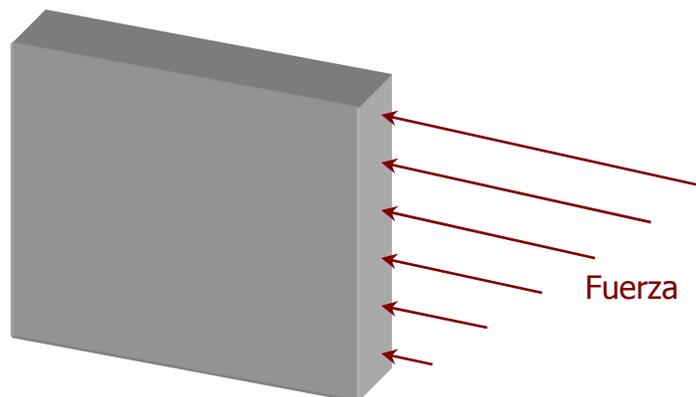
Plano de Acción de una fuerza sobre un muro de cortante
